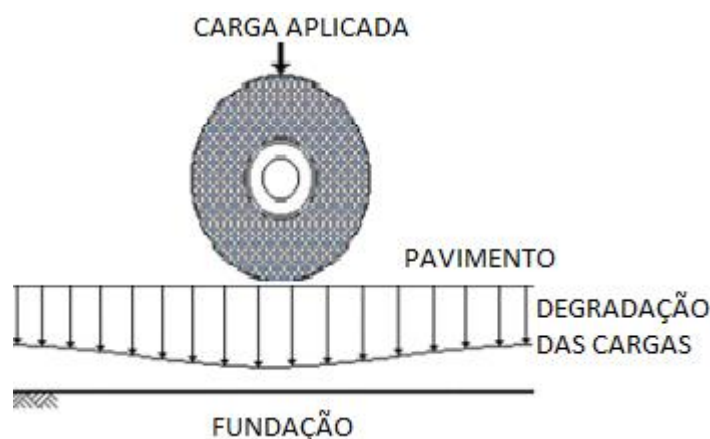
Efeito da degradação das cargas num pavimento rígido (Pavimentos, 2009)
